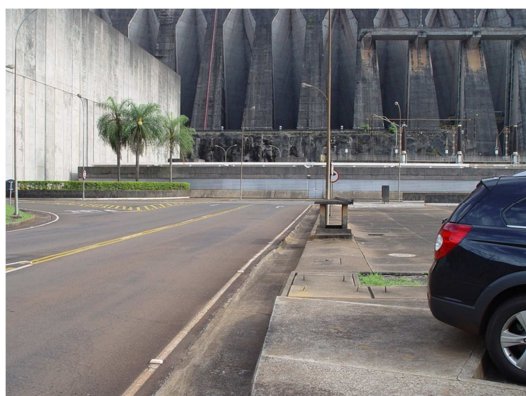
à esquerda: vista do traçado da galeria em paralelo com a via asfáltica
